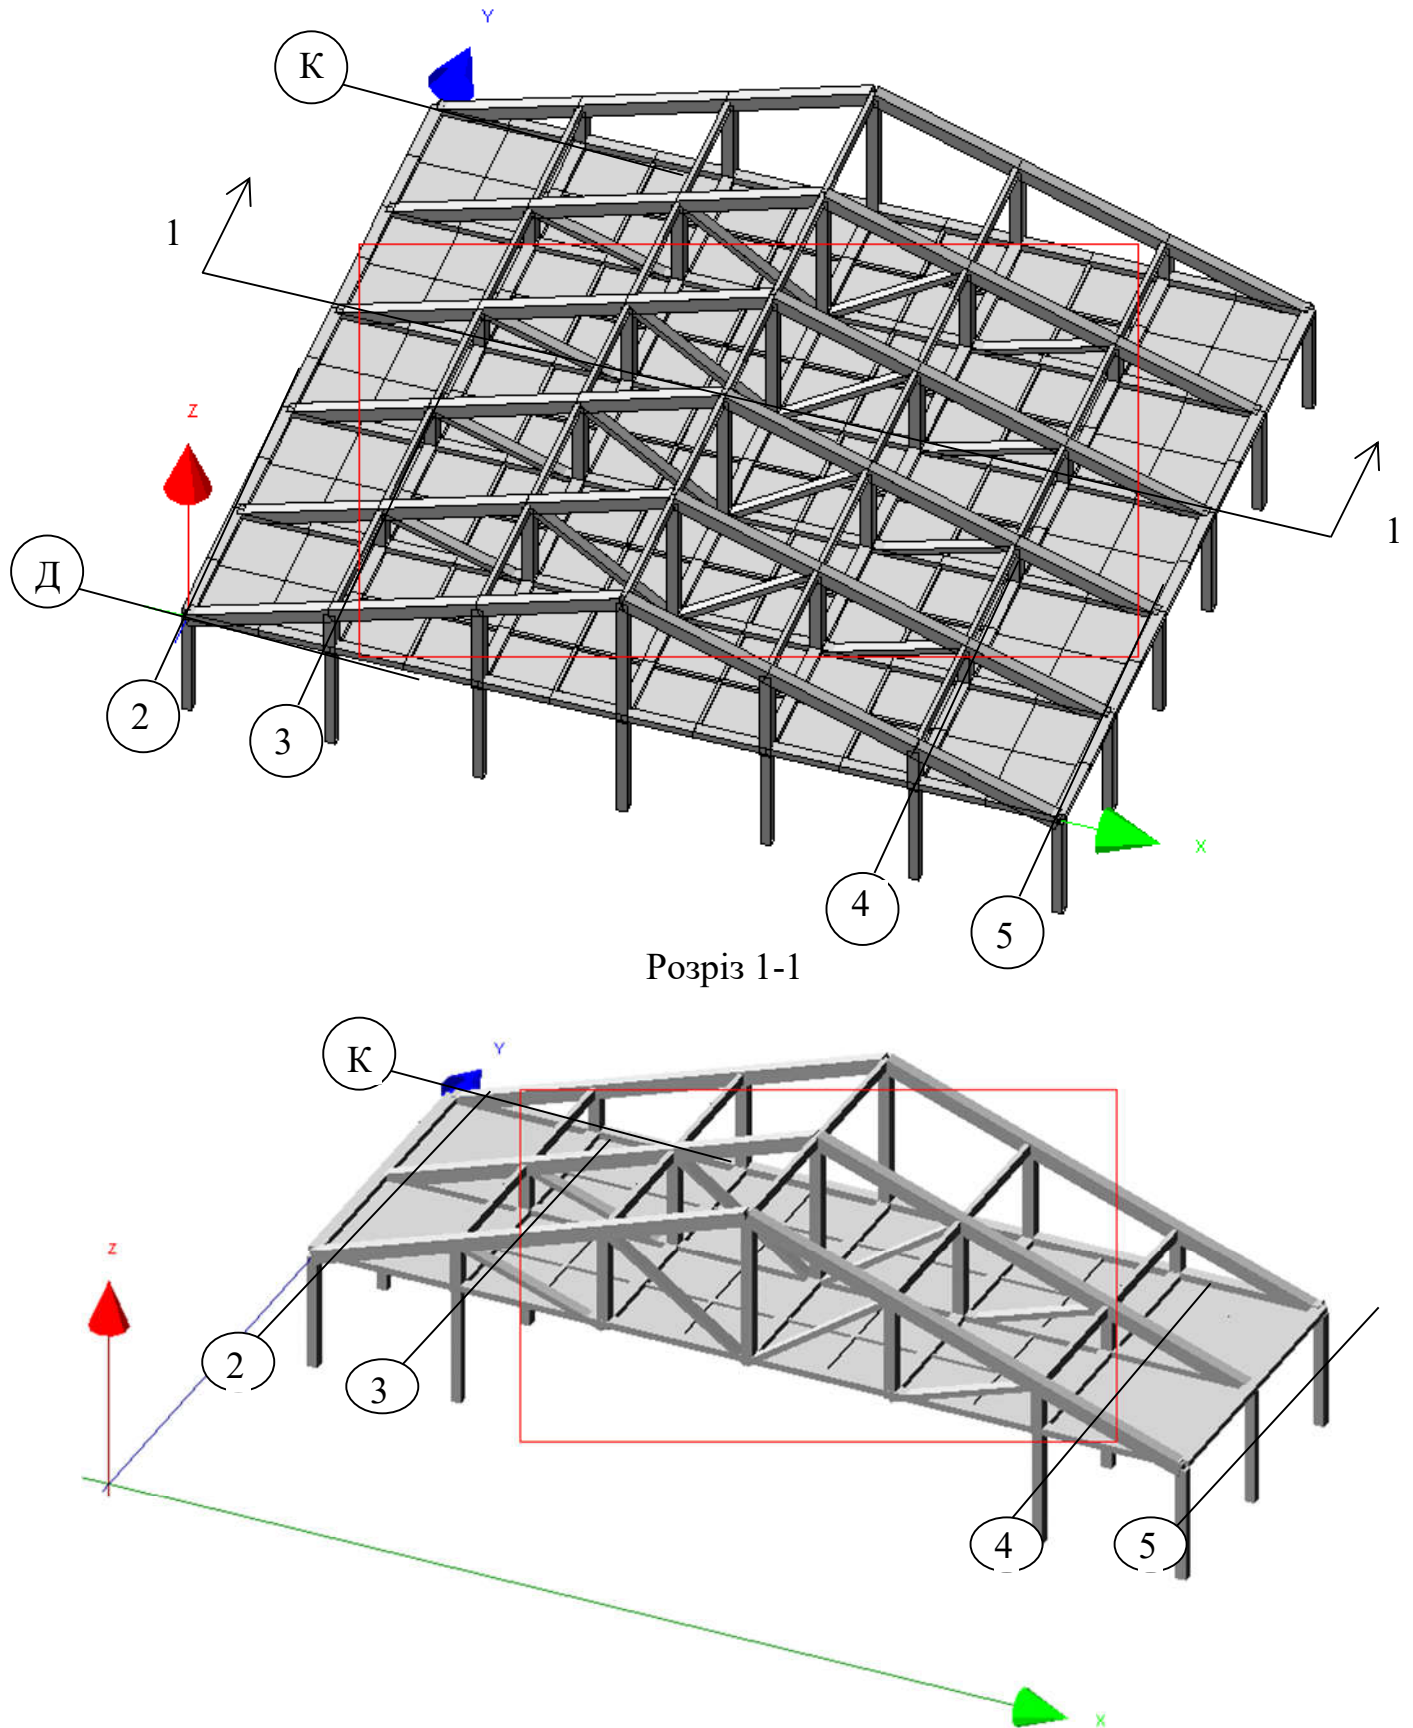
Розрахункова схема монолітного перекриття з фермами у 3D
